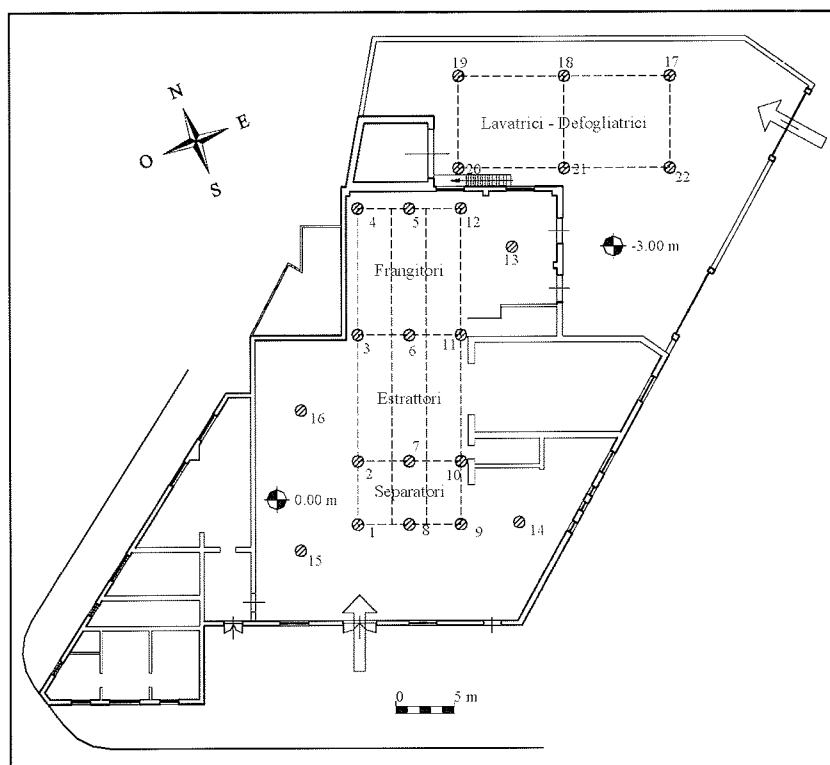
Planimetria frantoio continuo "I", con l'indicazione dei punti di posizionamento degli strumenti di misura.
